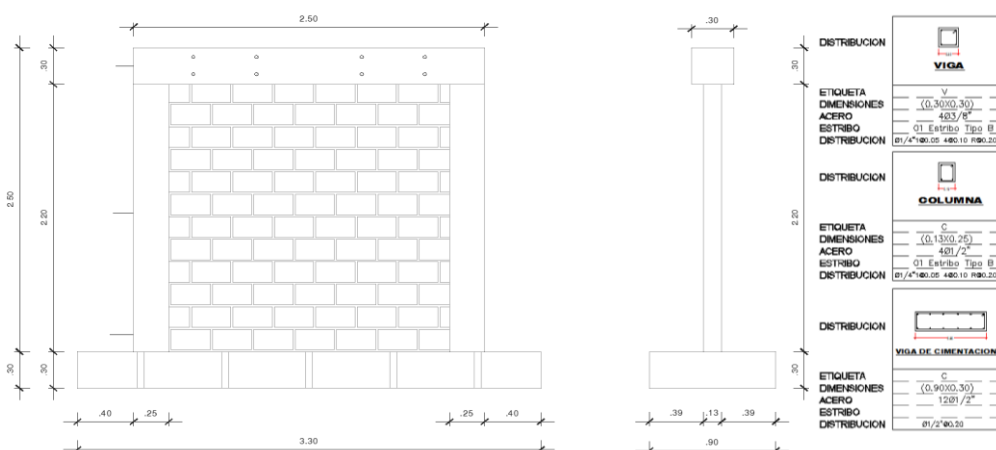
Dimensiones del muro y detalles de elementos de confinamiento.
